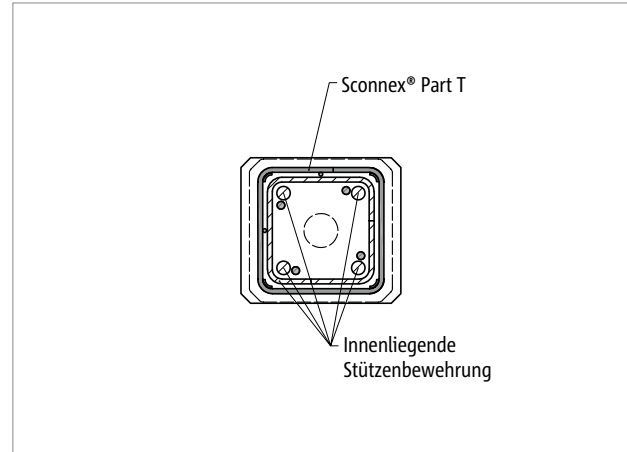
Schöck Sconnex® Typ P: Bewehrungsführung im Bereich 1 – Stützenquerschnitt
